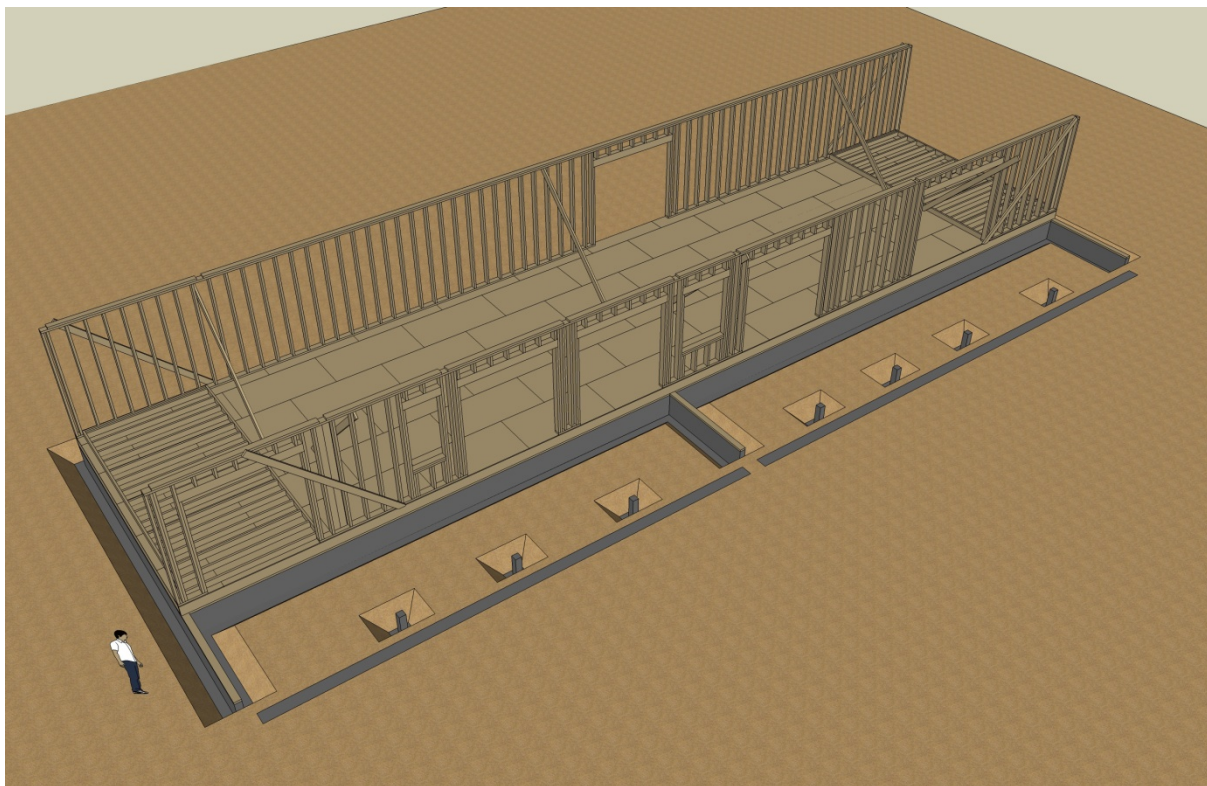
Montagem das paredes exteriores (de topo) sobre o pavimento.
